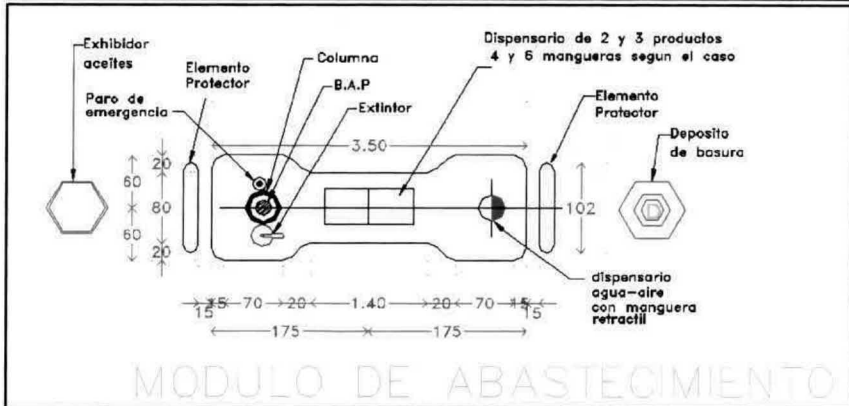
Dispensario proyectado Fuente. Plano Planta de Conjunto A1 de fecha 08 de marzo de 2016.
